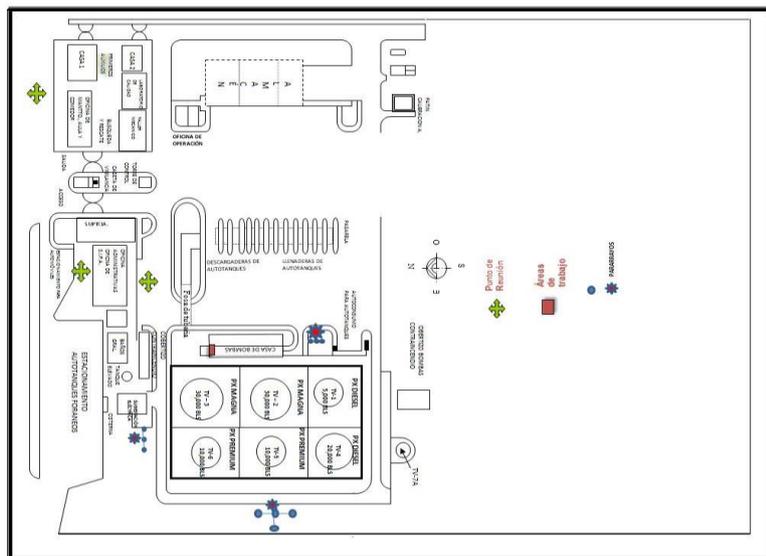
Croquis de la planta: PEMEX REFINACIÓN
